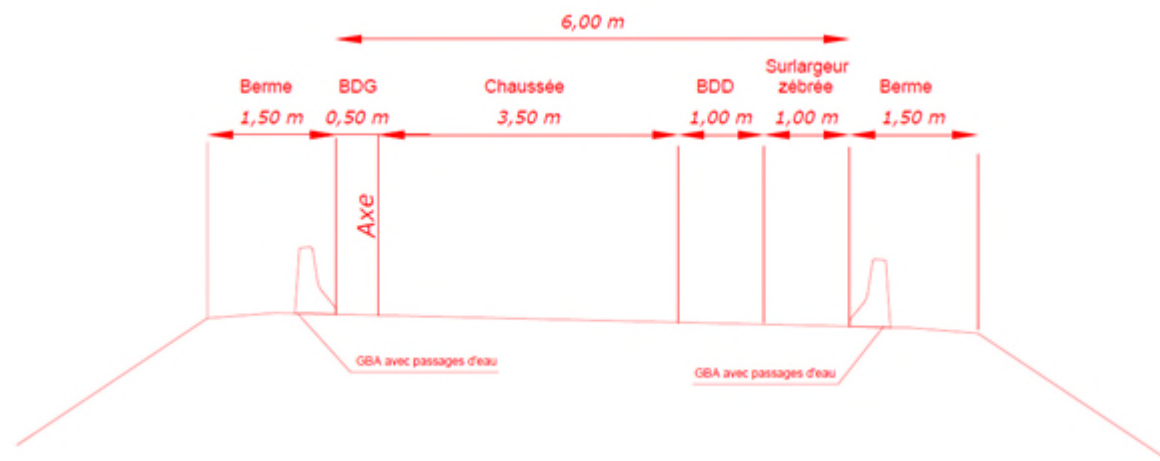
Profil en travers type de la section routière (Source VERDI)
